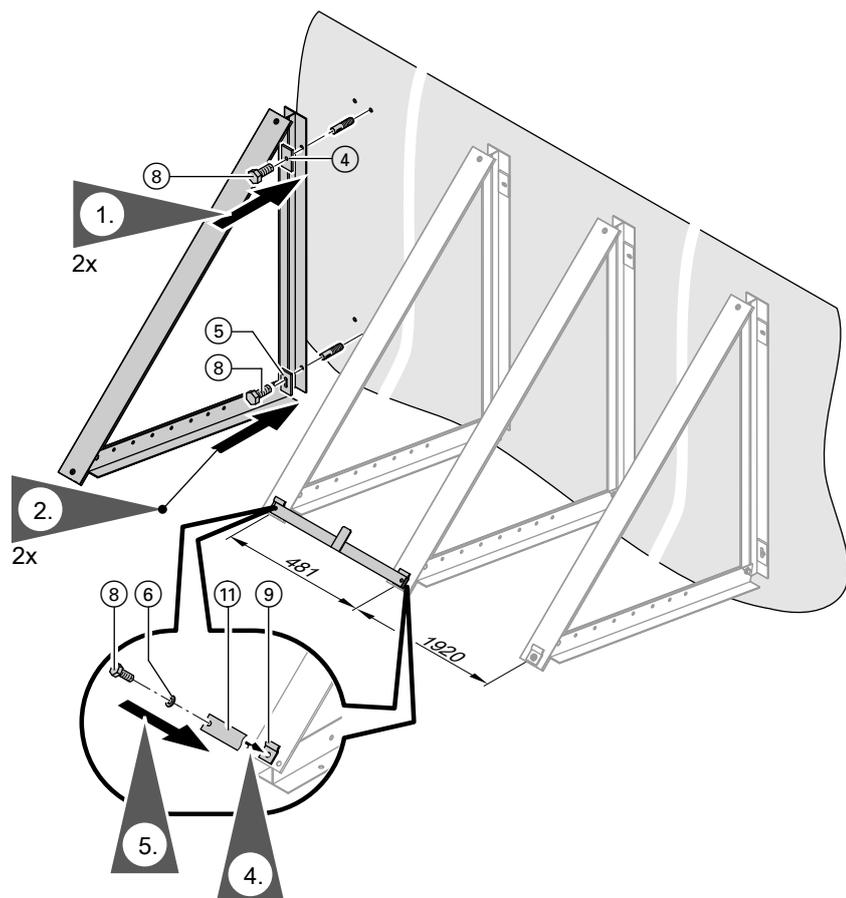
Использовать опорные стойки в качестве шаблона для сверления.
